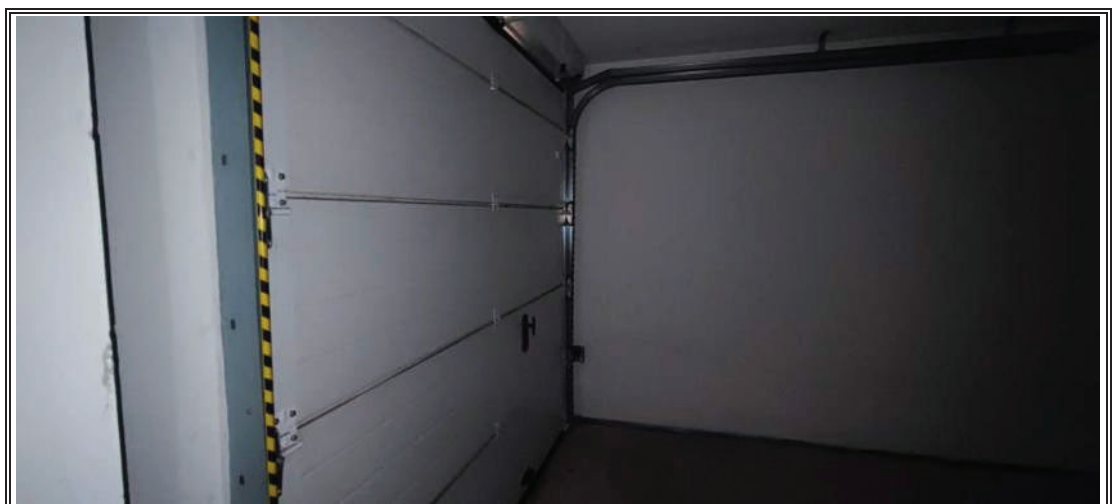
Appartamento mapp. 1580 sub 3 – Garage piano interrato
